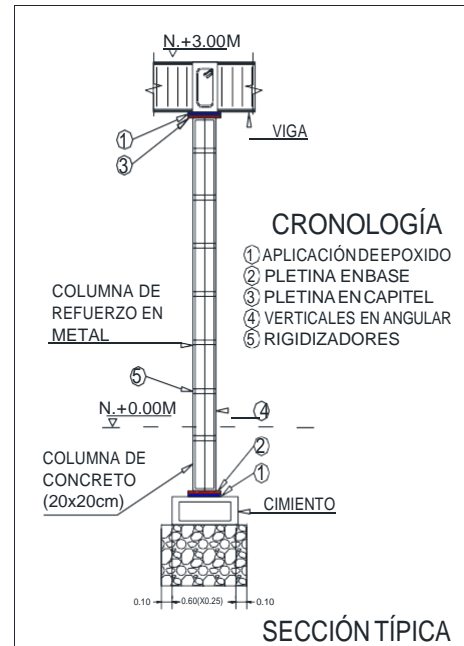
VISTA EN ALZADO DE LA COLUMNA.
